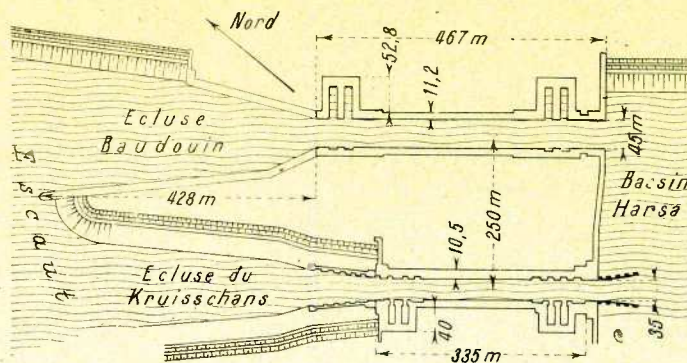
Plan d'ensemble des écluses Kruisschans et Baudouin.
